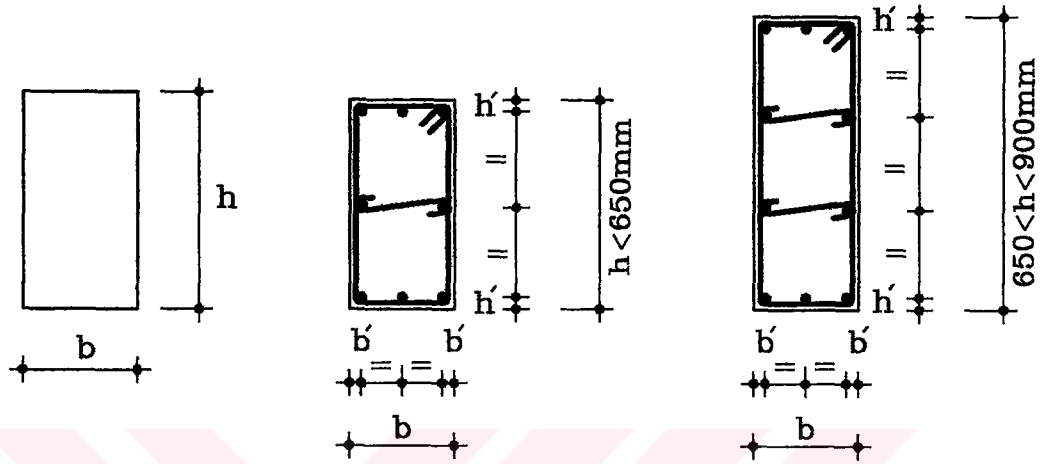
Kiriş Enkesit Boyutlarını Tanımlayan Büyüklükler ve Donatı Yerleşim Düzeni
